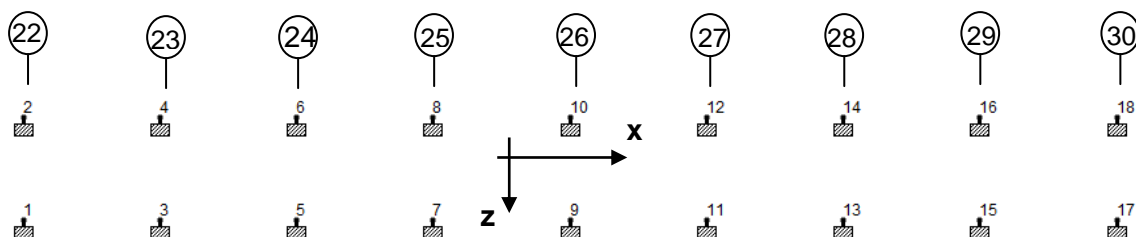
Planta de apoyos parral Este-Oeste ejes 22 al 30
